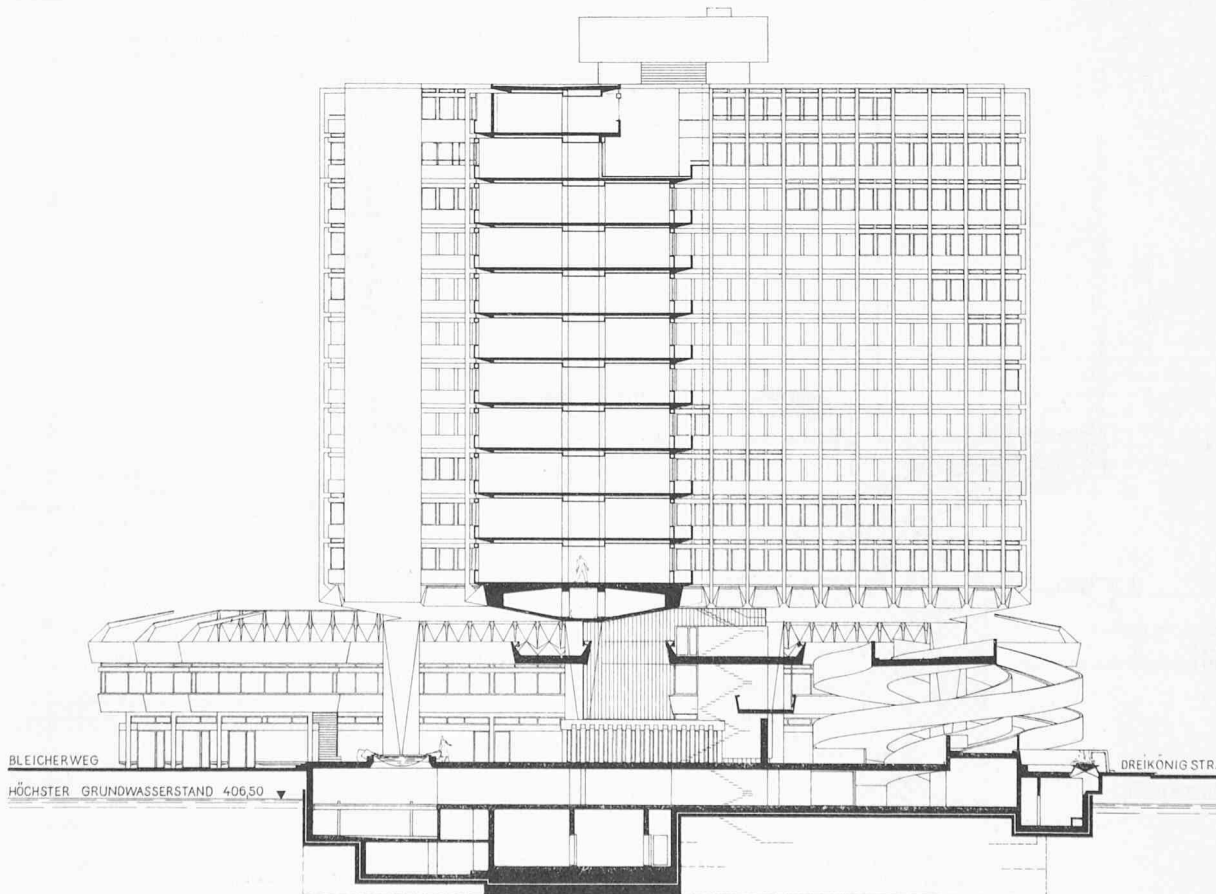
Fassade 1:500 gegen Dreikönigstrasse mit Autorampe
